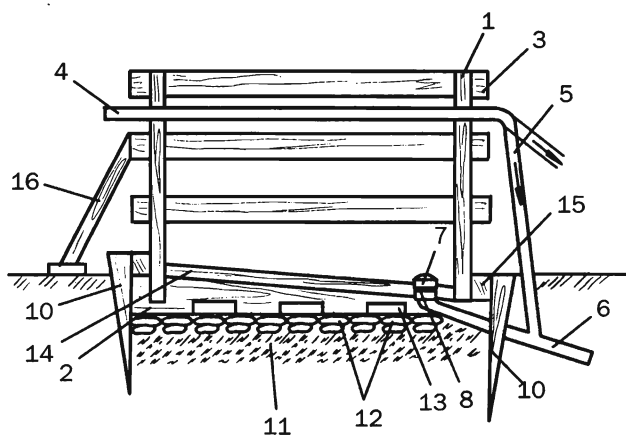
Наземный бассейн из дерева: 1 — деревянные щиты; 2 — лаги; 3 — брусья; 4 — труба для подачи воды; 5 — переливная труба; 6 — сливная труба; 7 — защитный фильтр; 8 — шайбы и уплотнительные прокладки; 9 — лестница; 10 — костьль; 11 — грунт; 12 — гравий; 13 — деревянное основание; 14 — деревянное дно; 15 — фиксирующий брус; 16 — планка жесткости
